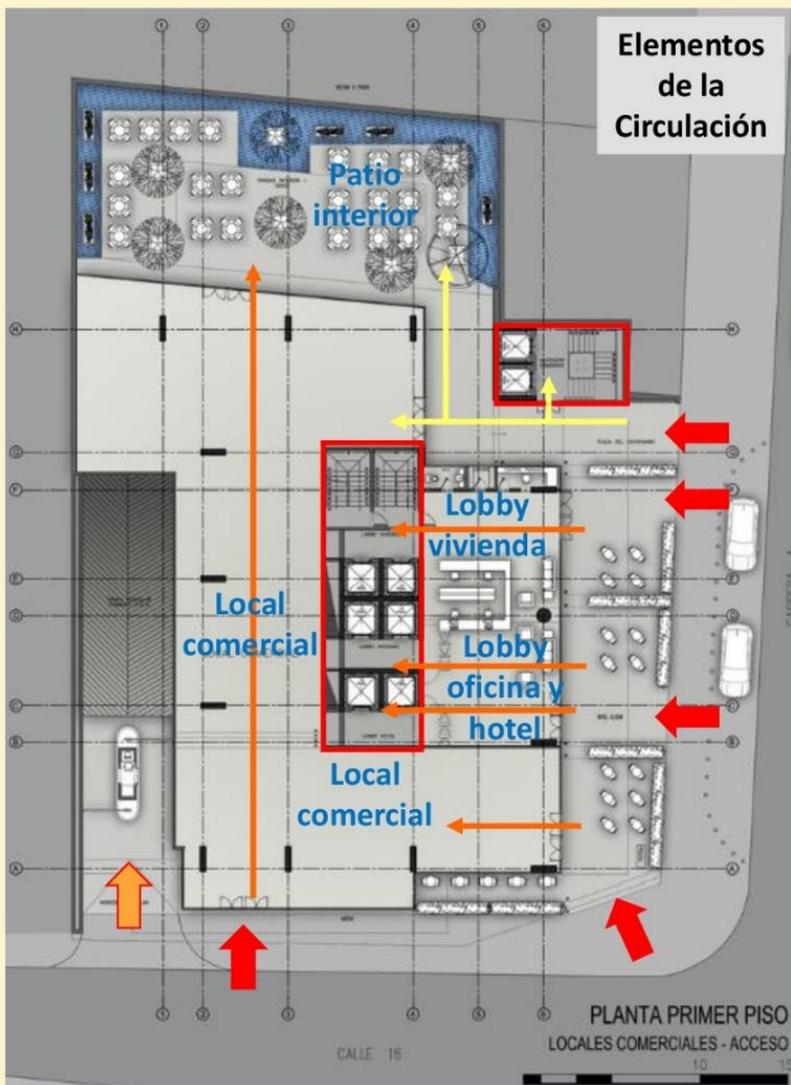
Primera Planta escala 1:300 Fuente: www.archdaily.pe
